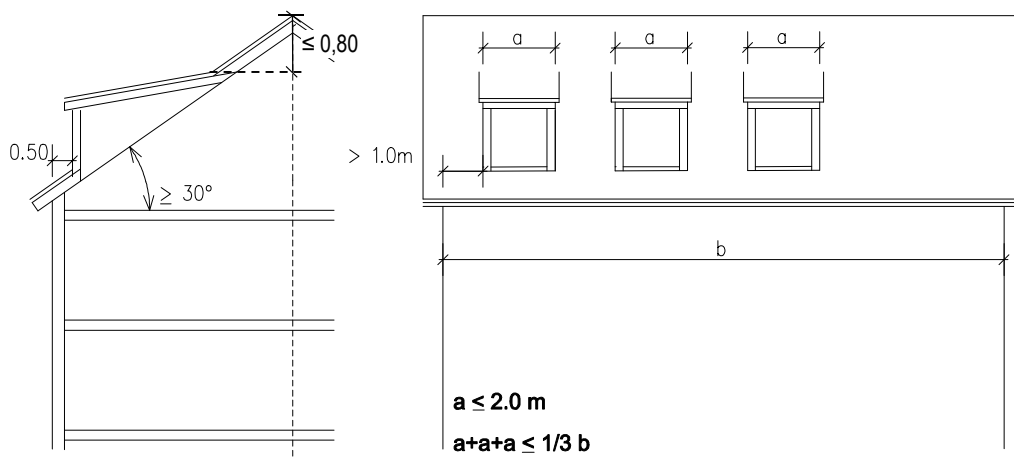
Anordnung und Abmessung von Dachaufbauten
